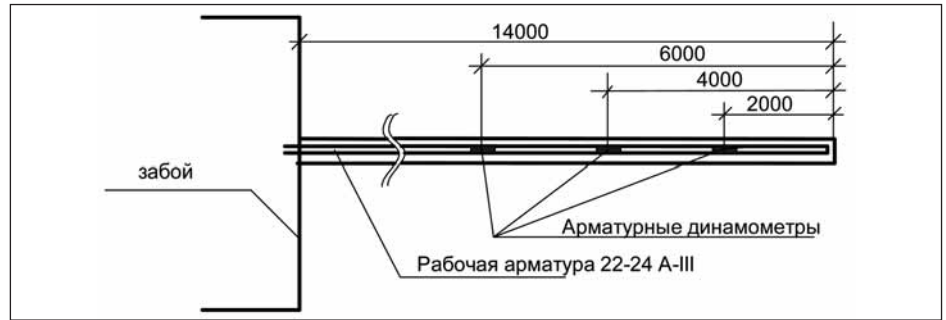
Схема размещения арматурных динамометров в анкере опережающего крепления лба забоя
